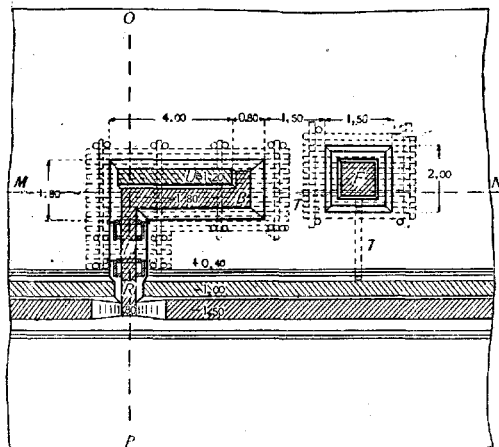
Легкое вентиляционное убежище с фильтром из растительной земли: R—вход; L—тамбур; U—убежище; B—вентилятор; T—трубы, проводящие воздух; F—фильтр.
